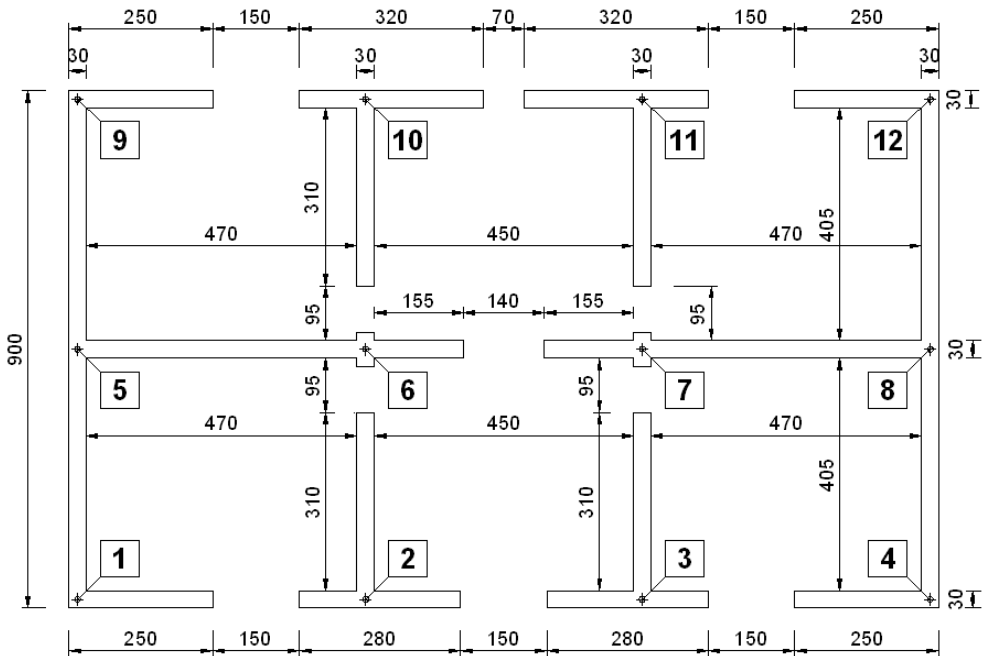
Dimensioni degli elementi strutturali del secondo piano f.t.
